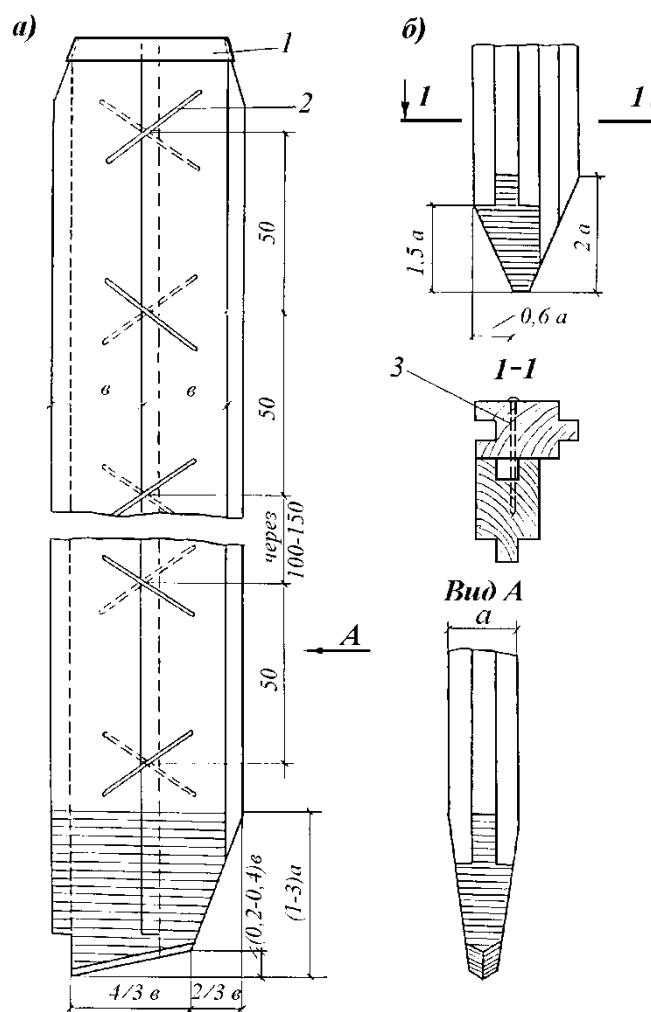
Конструкция пакетных деревянных шпунтовых свай:
